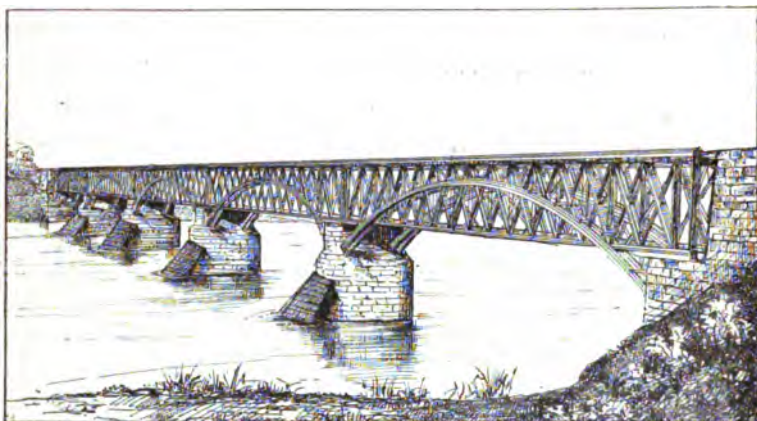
Poutre Howe renforcée par des Arcs en Charpente.
